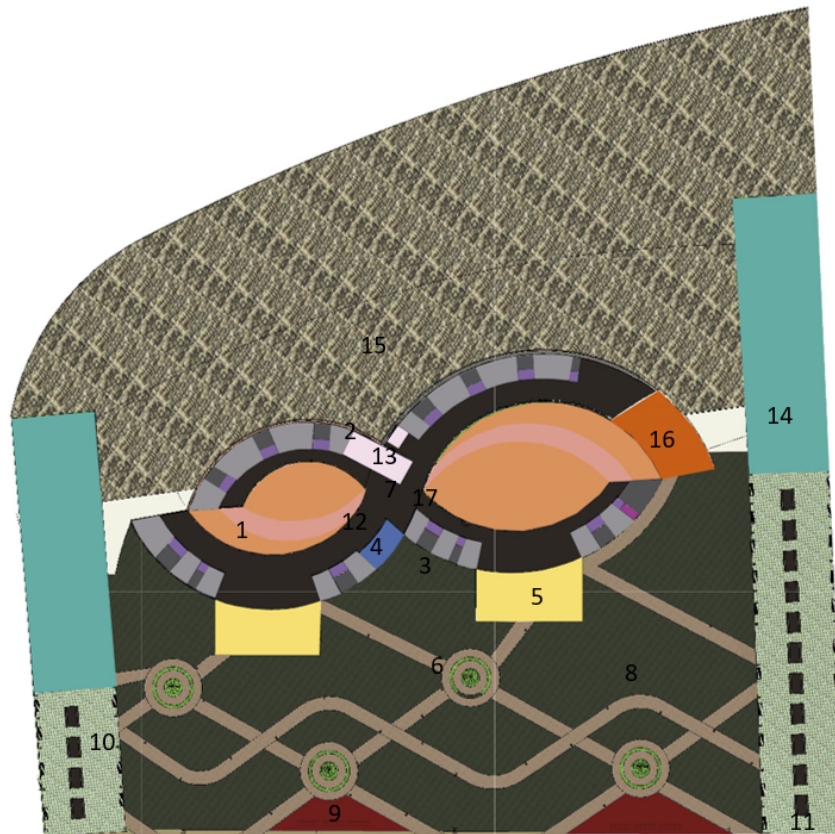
Primera Planta. Fuente y elaboración: Propia.
